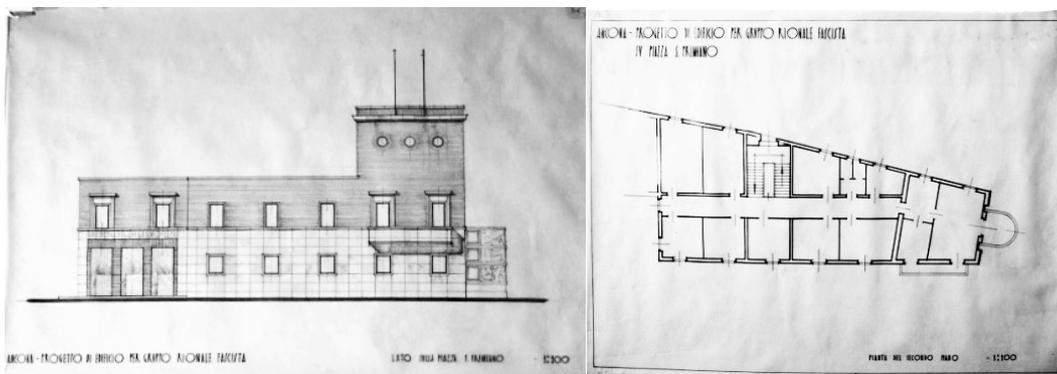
Pianta e Prospetto del dopolavoro a p.zza San Priamo, Ancona. ASAn, Fondo Luchetti
